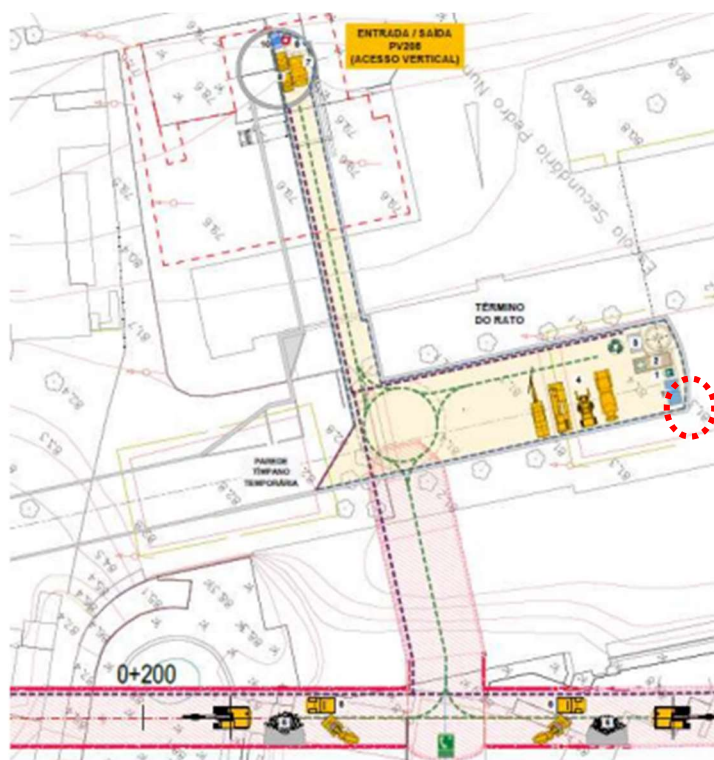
Estaleiro PV208- Instalações de Apoio (subterrâneas)
